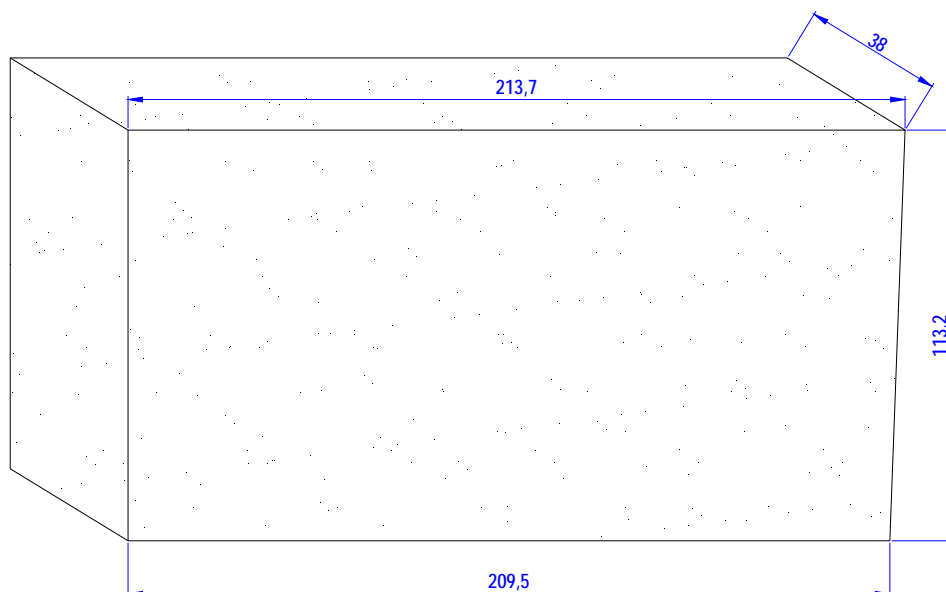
Geometría del muro de tapial construido en laboratorio (cotas en cm.)
